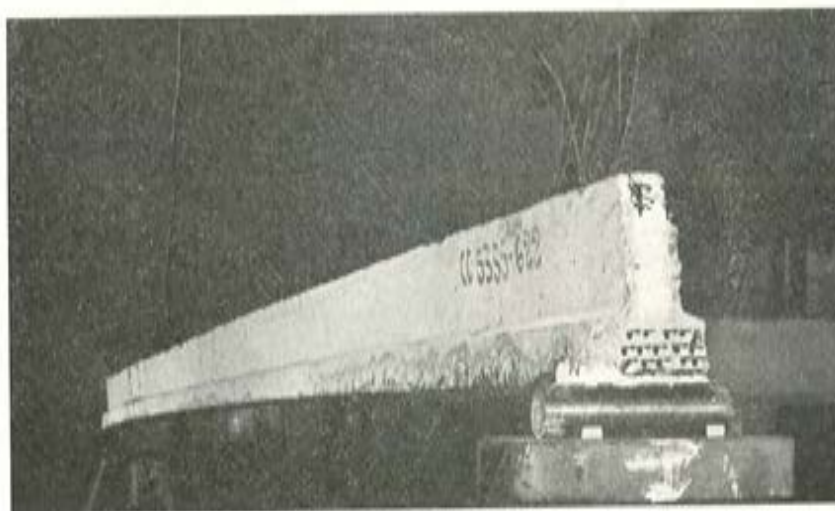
Vigüeta semirresistente con estribos salientes.
